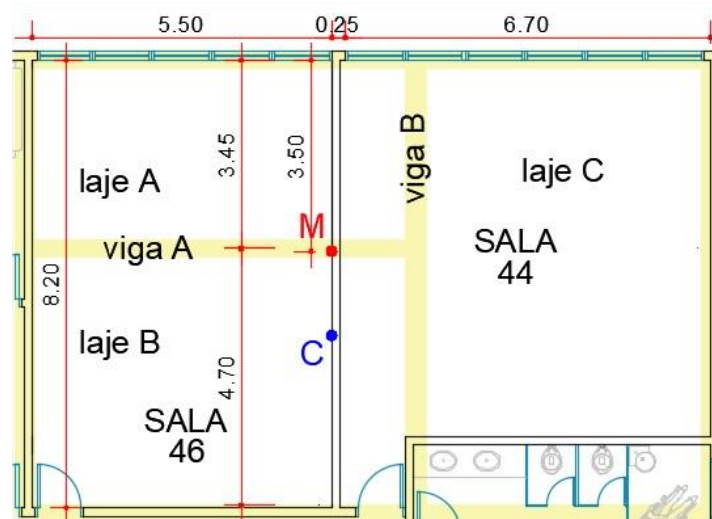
Planta esquemática com localização de vigas e pontos com rachaduras
